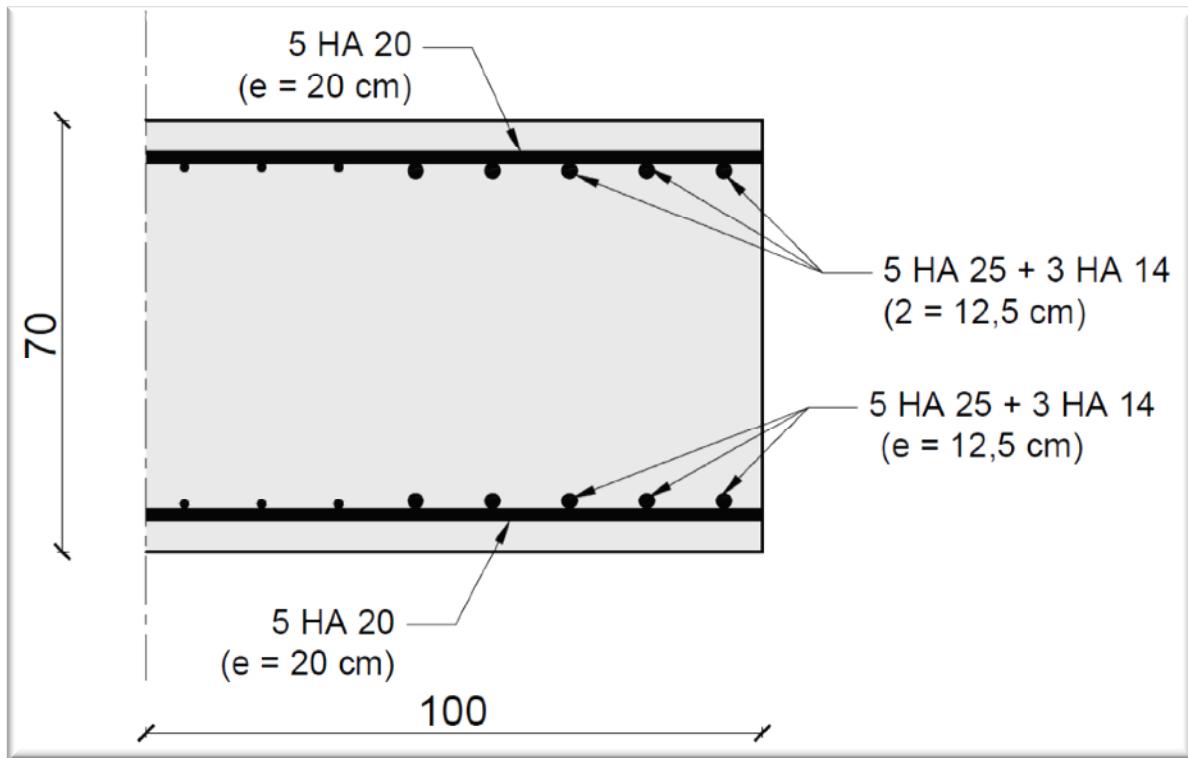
Schéma de ferrailage de piedroit latéral.
